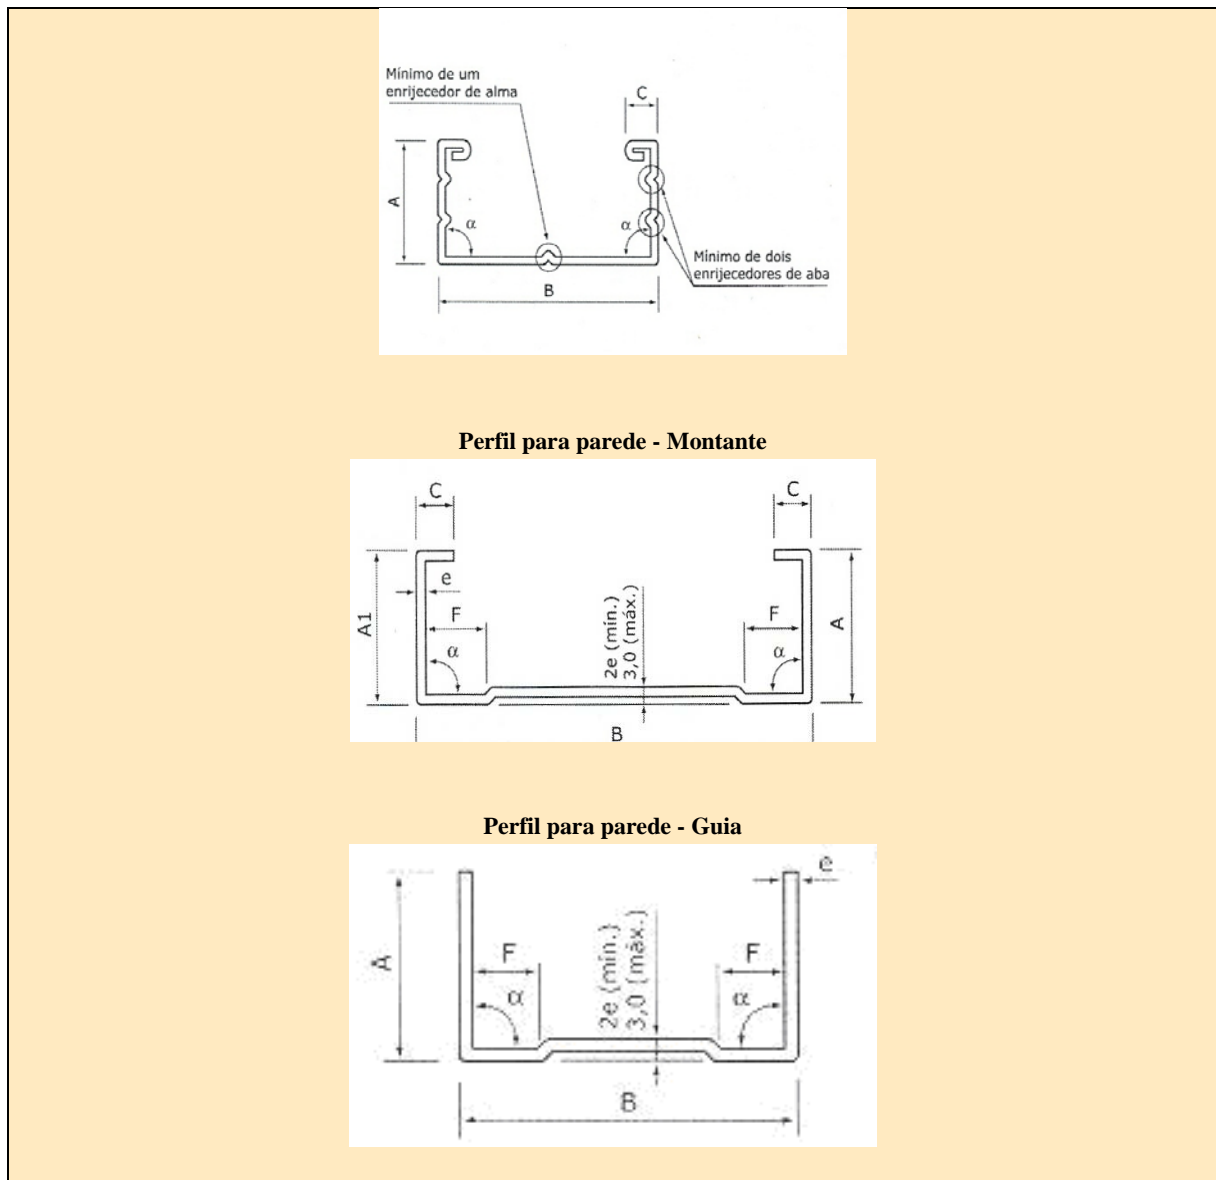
Ilustração do perfil de aço galvanizado para drywall com chapas de gesso
